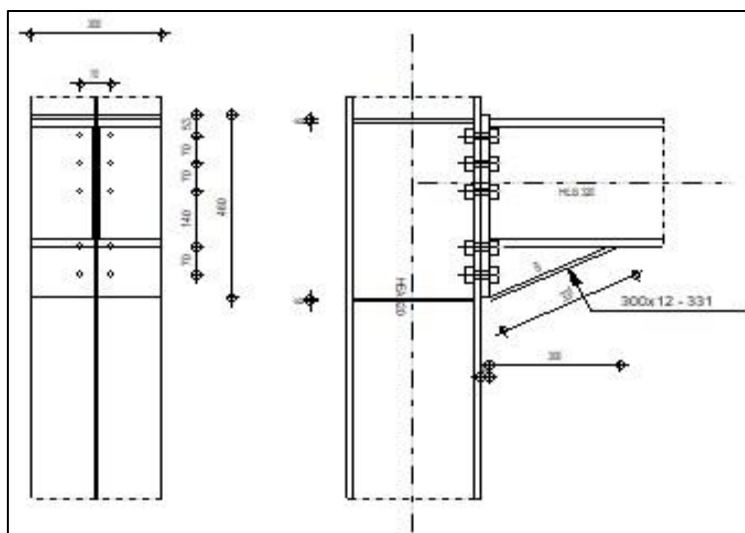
Représentation de l'assemblage support poutre pont roulant - poteau.
